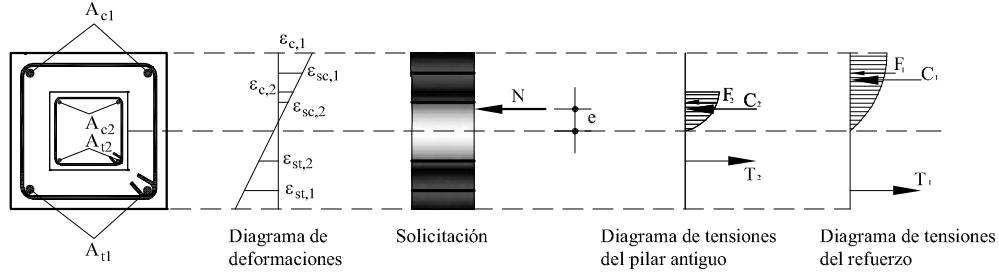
Cálculo seccional de un refuerzo como sección compuesta. Se considera un único plano de deformaciones (ejemplo de flexocompresión de un pilar descargado sin precarga en el instante del refuerzo).
